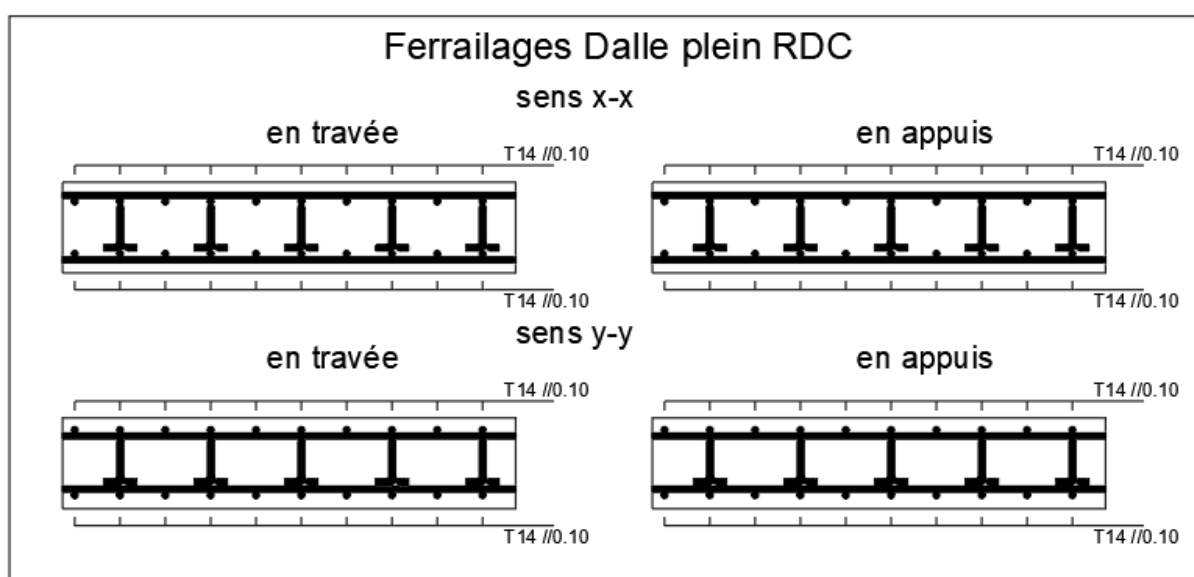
Schéma de Ferrailages Dalle plein RDC.
